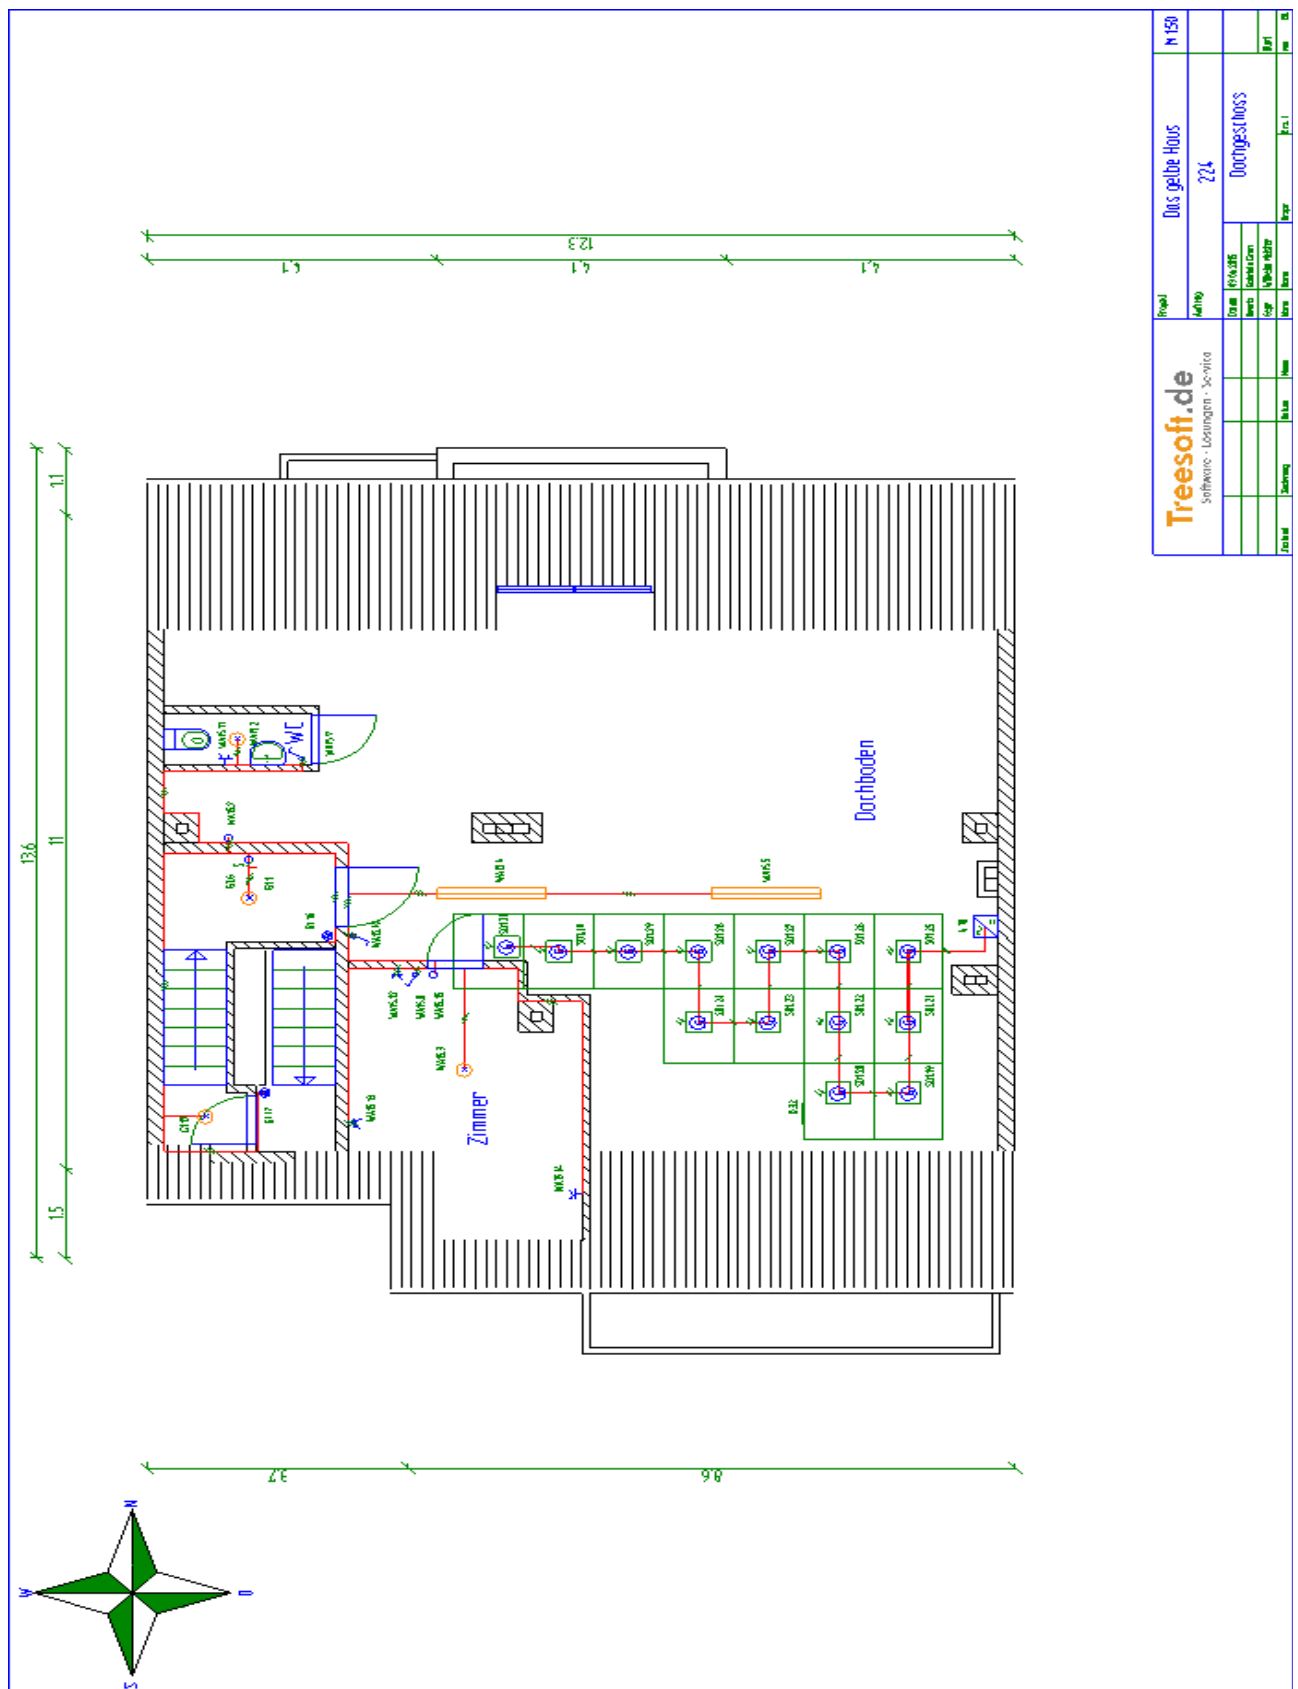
Dachgeschoss eines Mehrfamilienhauses
